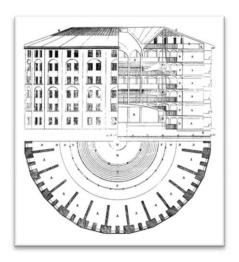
Elevação, seção e plano do Panóptico de Benthan (1791).
